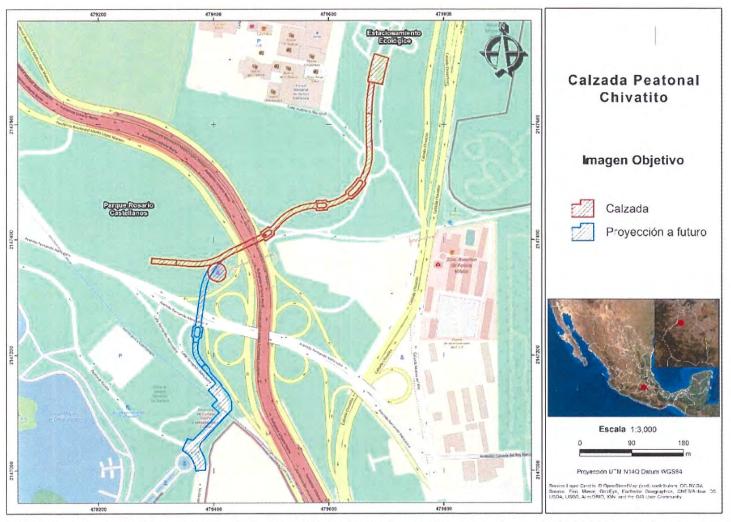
Esquema en planta del anteproyecto Calzada Peatonai Chivatito. Se muestra en achurado rojo el proyecto objeto de este estudio y en achurado azul la ampliación del proyecto a desarrollarse en el futuro.
